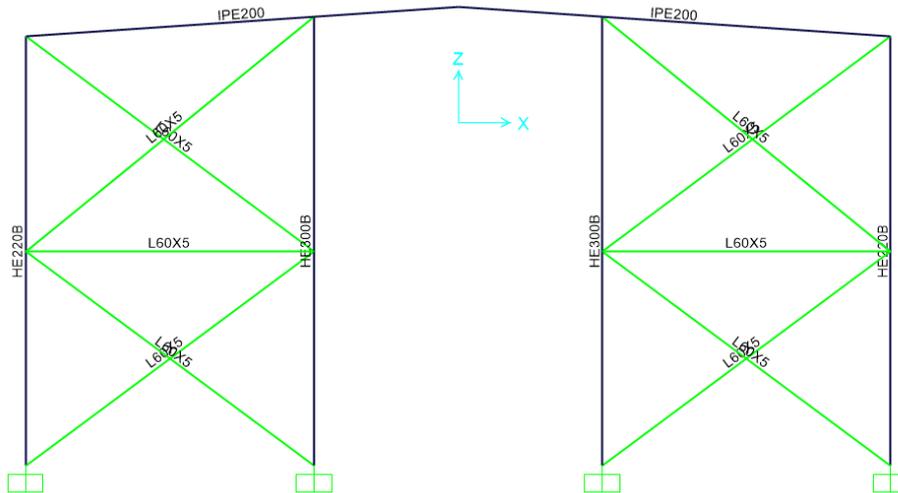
Pórtico de fachada tipo. (Sap200).
